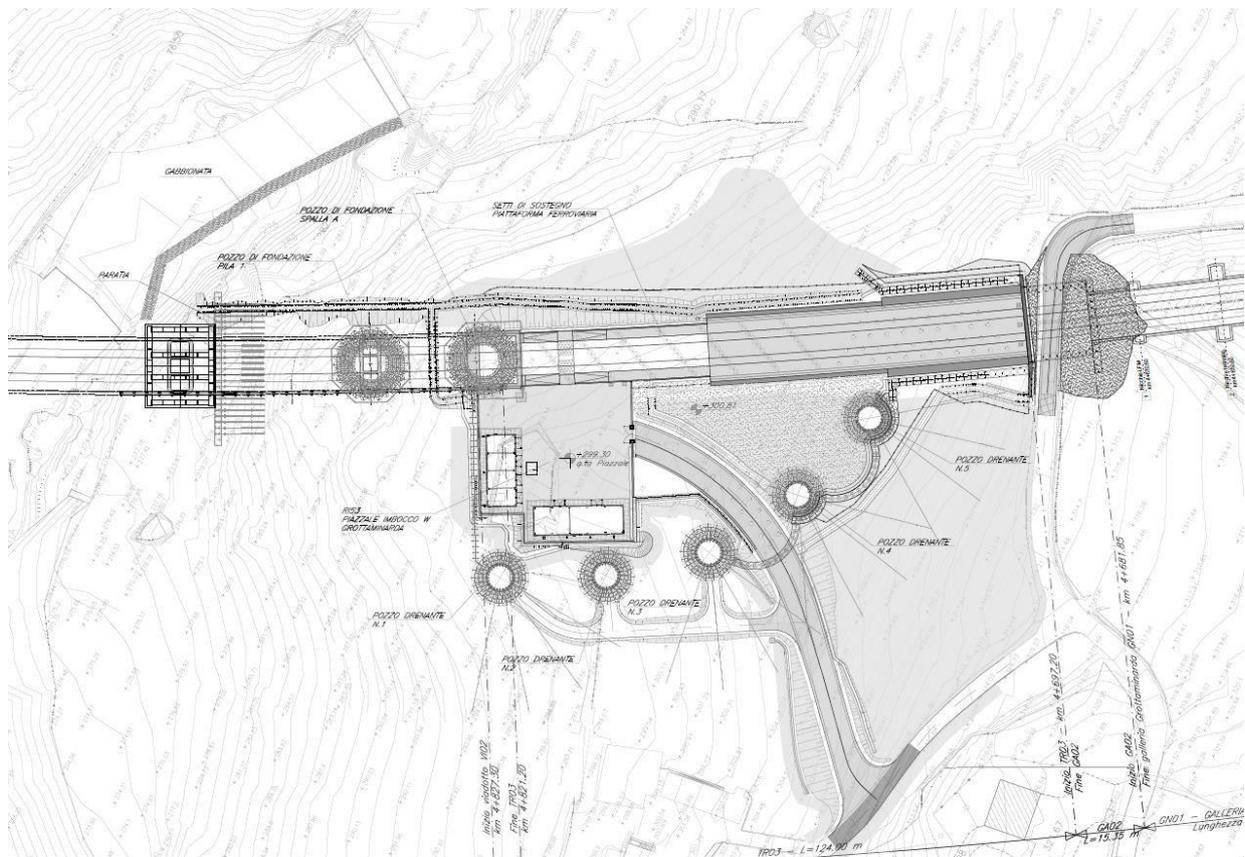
Estratto tavola di progetto con individuazione degli interventi di stabilizzazione del versante e della viabilità accessoria
